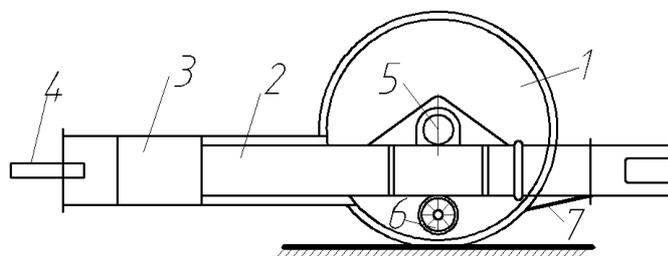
Прицепной каток с металлическими вальцами: 1-пустотелый валец цилиндрической формы; 2-рамы; 3-дышла; 4-цепное устройство; 5-торцевые шипы (валец соединен с рамой через подшипники на торцевых шипах); 6-люк с балластом (песком) для массы; 7-скребок для очистки вальца от налипшего грунта.
